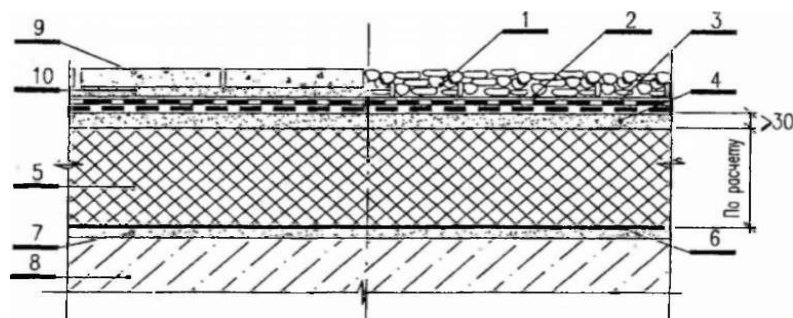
Неэксплуатируемая кровля с тяжелым покрытием и свободной укладкой первого слоя водоизоляционного ковра
